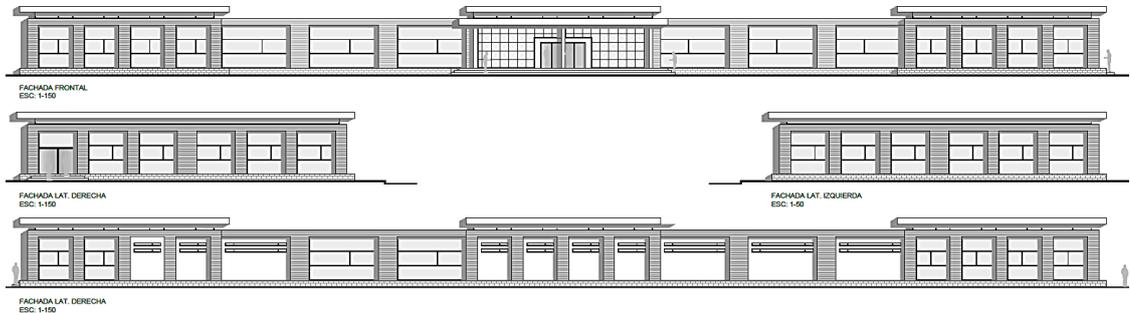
Fachada del área de aprendizaje - escuela
